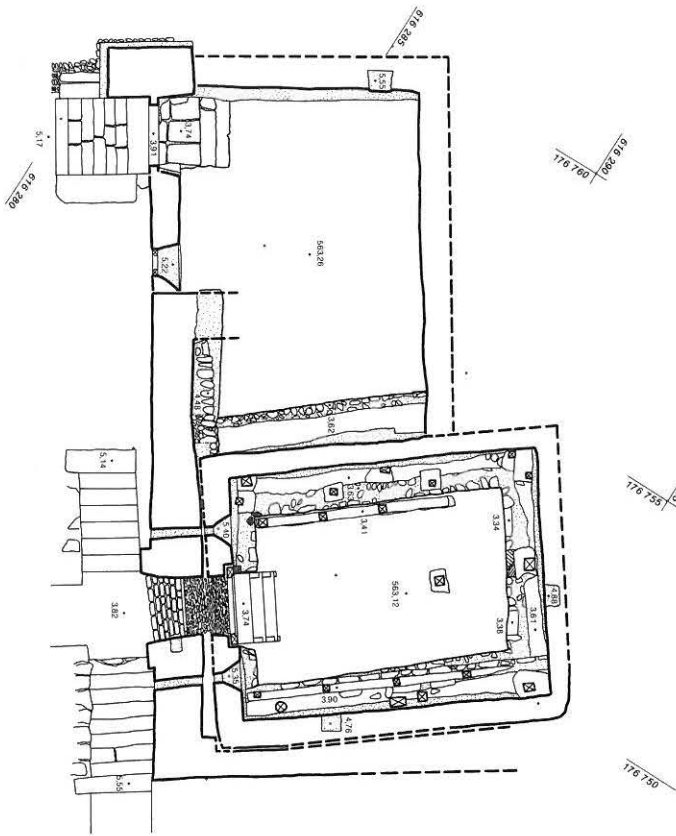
Hilterfingen, alte Thunstrasse 36. Grundriss des Kellergeschosses mit Befunden. M. 1:150.
